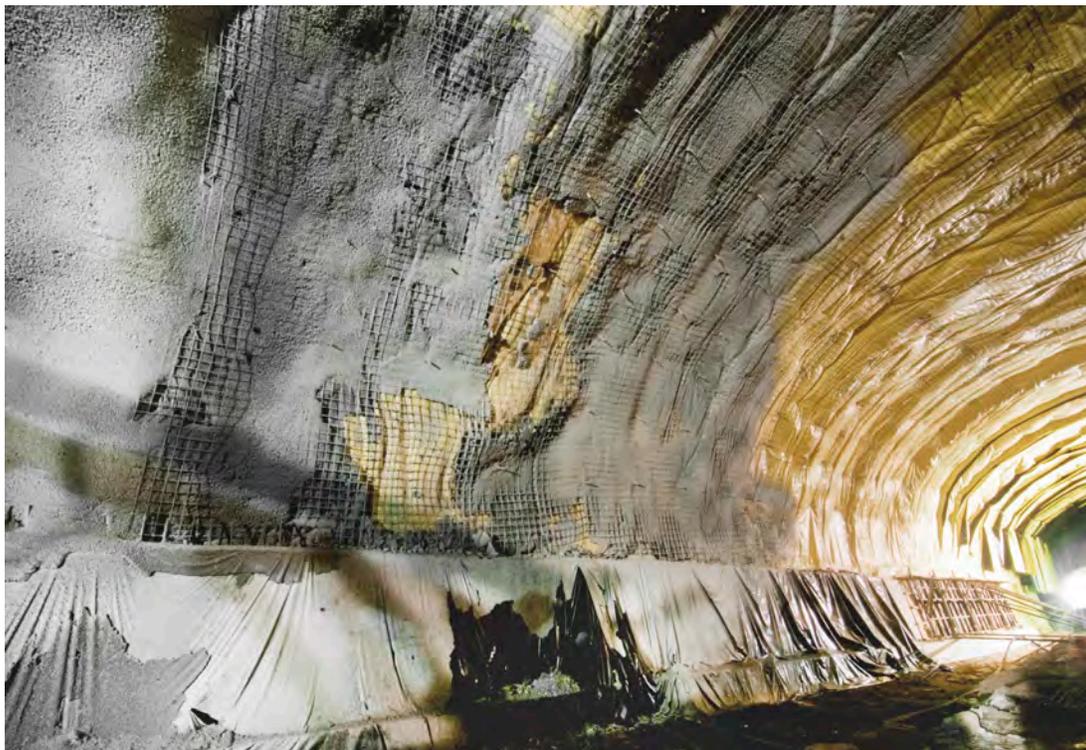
Zona de desprendimiento de la primera capa de concreto lanzado y separación de la malla. Túnel Chimalpa I. Carretera Toluca-Naucaipan. Consultec Ingenieros Asociados, 2015.
